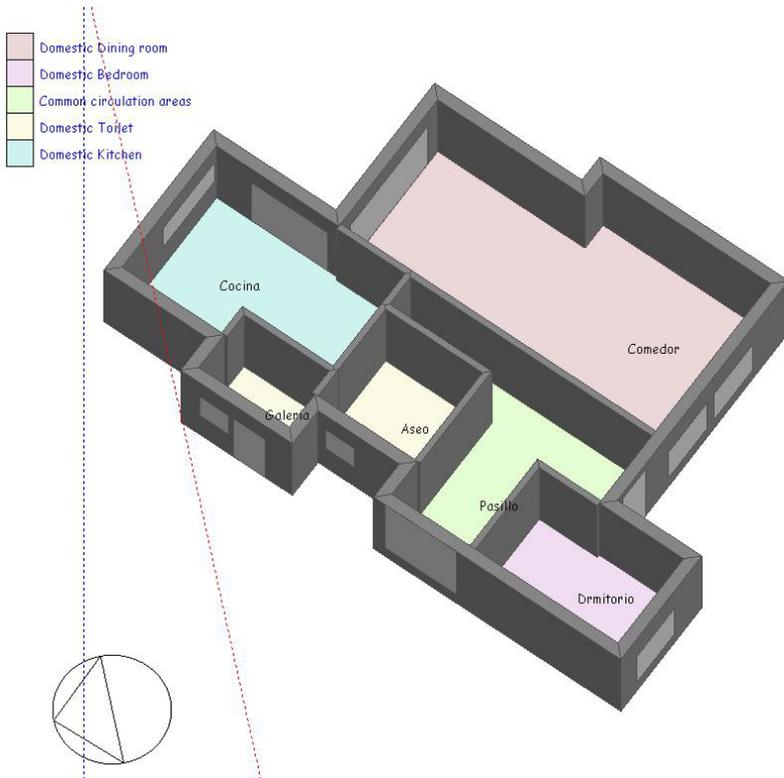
Planta baja de nuestra vivienda. Fuente propia DesignBuilder
